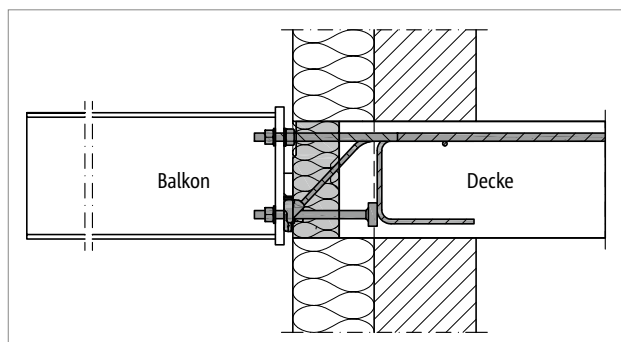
Schöck Isokorb® T Typ SK: Dämmkörper schließt mit Hilfe des Deckenvorsprungs außen bündig mit der Dämmung der Wand ab, dabei sind die seitlichen Randabstände zu beachten
